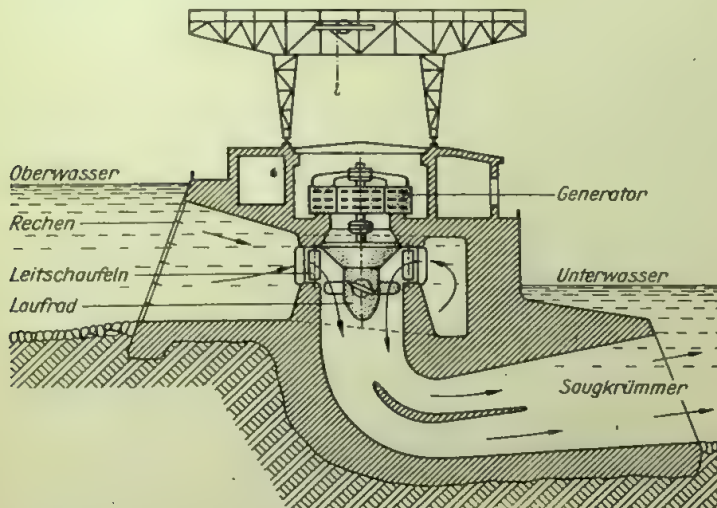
Aufbau eines Wasserkraftwerks nach dem Laufwasserprinzip mit Kaplan turbine
